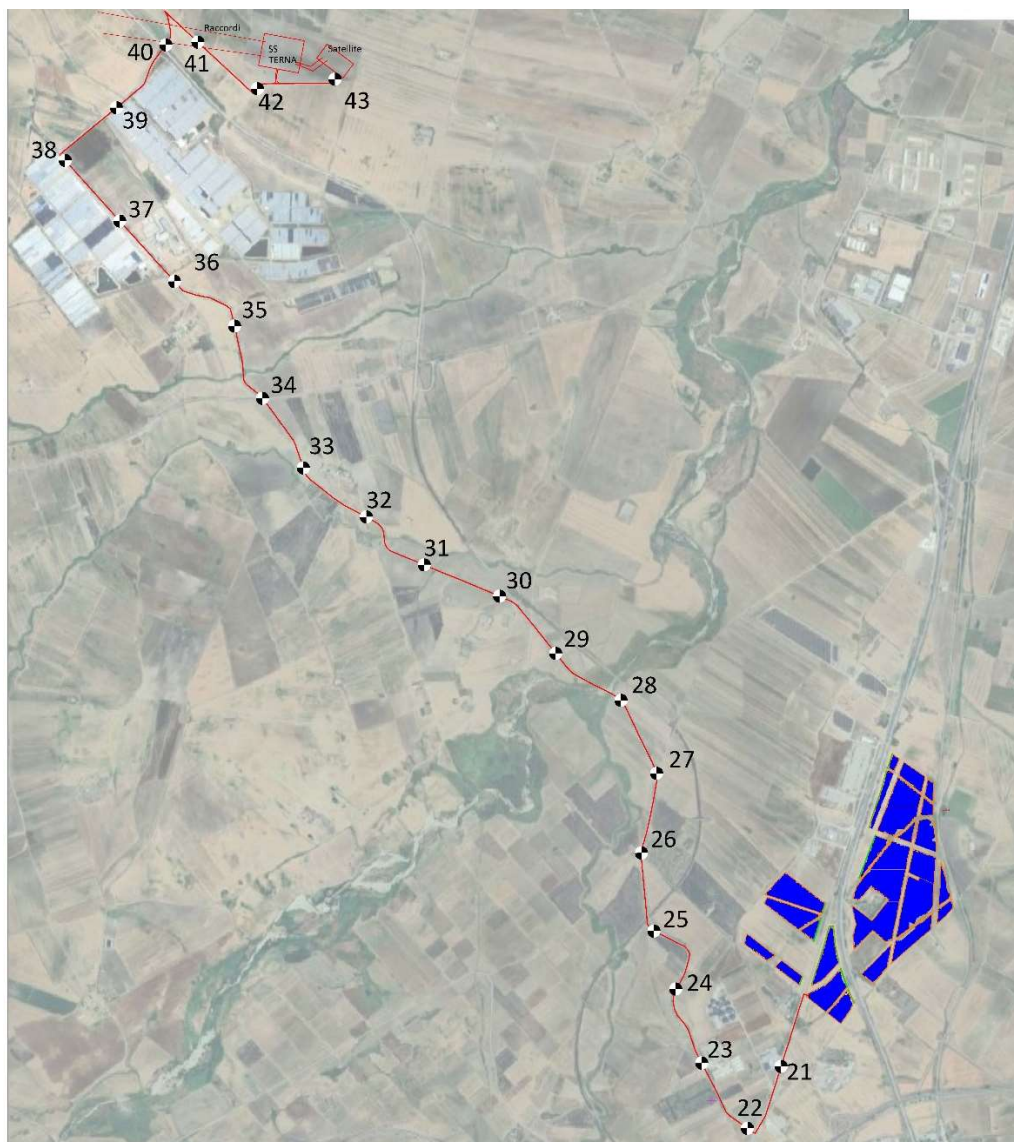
Planimetria cavidotto con ubicazione dei punti lineari di campionamento - terre e rocce da scavo
